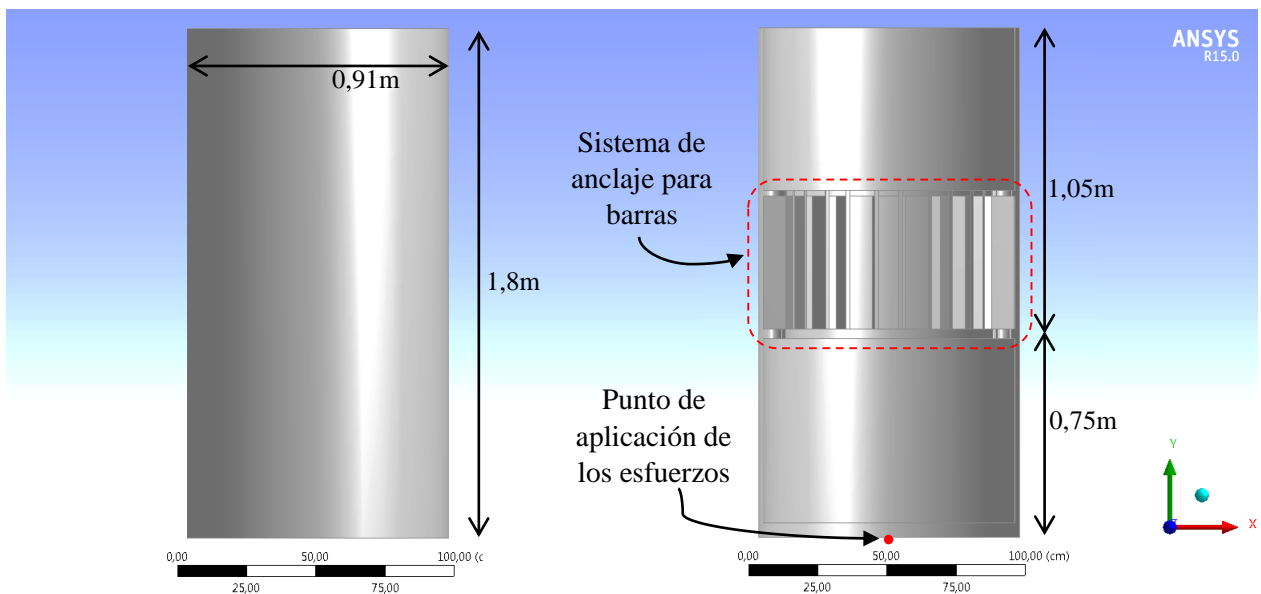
Vista exterior del pilote (izquierda) y vista interior del pilote (derecha).
